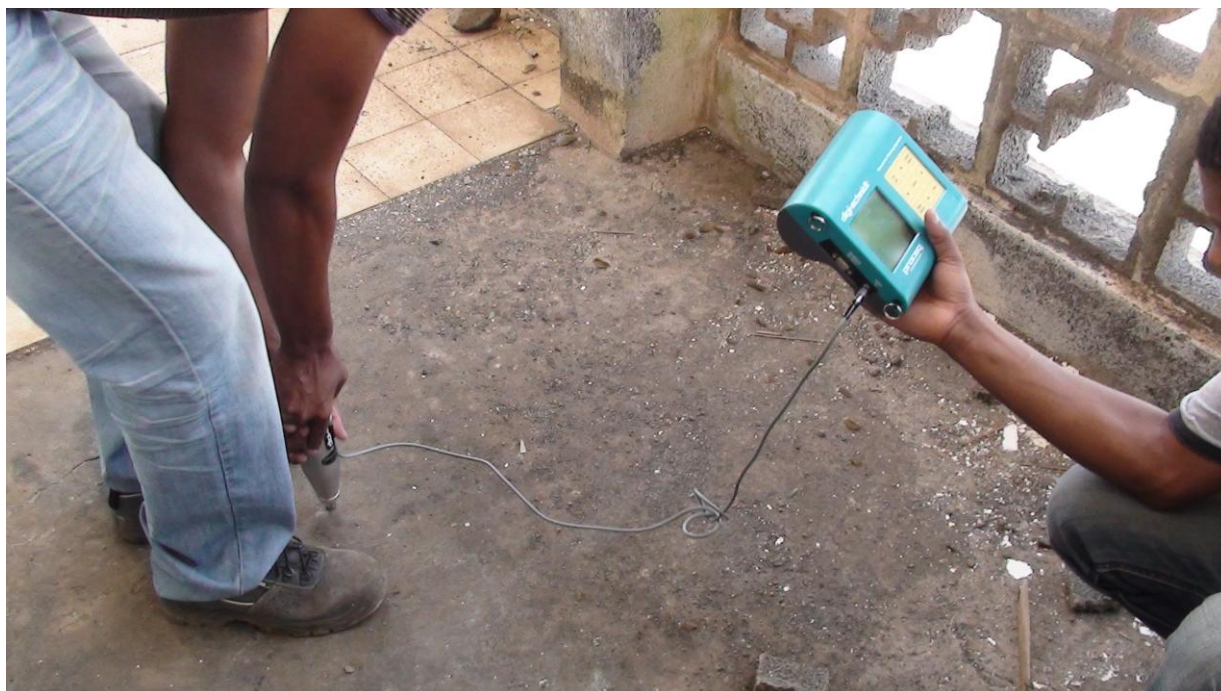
Ensaio de esclerómetro feito a laje [fonte: o autor]
